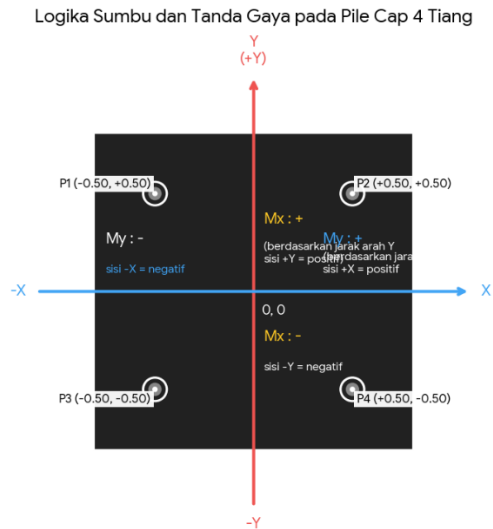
Detail Rencana Pondasi Dan Pile Cap.
